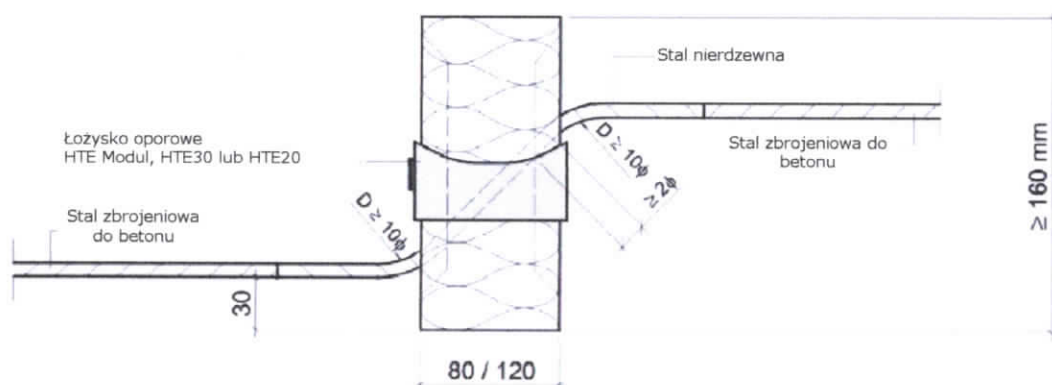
Schöck Isokorb® typu K-U i typu K-U-F
